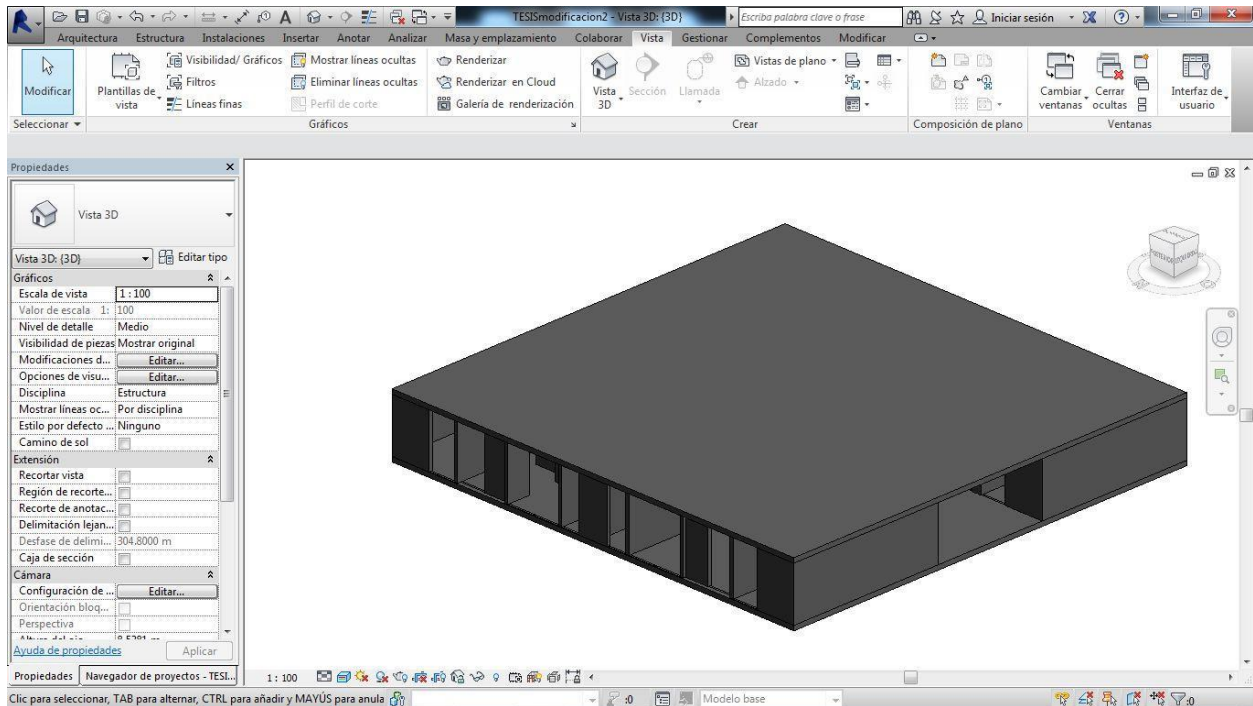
Placa de cimentación y muros piso 1 de la torre del proyecto.
